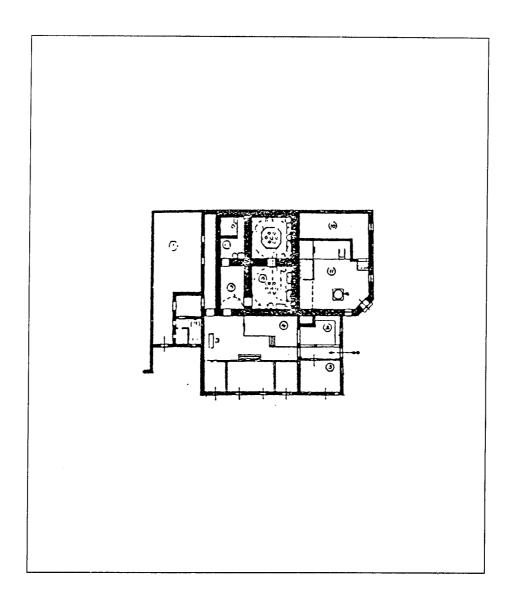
مسقط أفقي لحمام كرويا بألبانيا (عن :كيل) .
